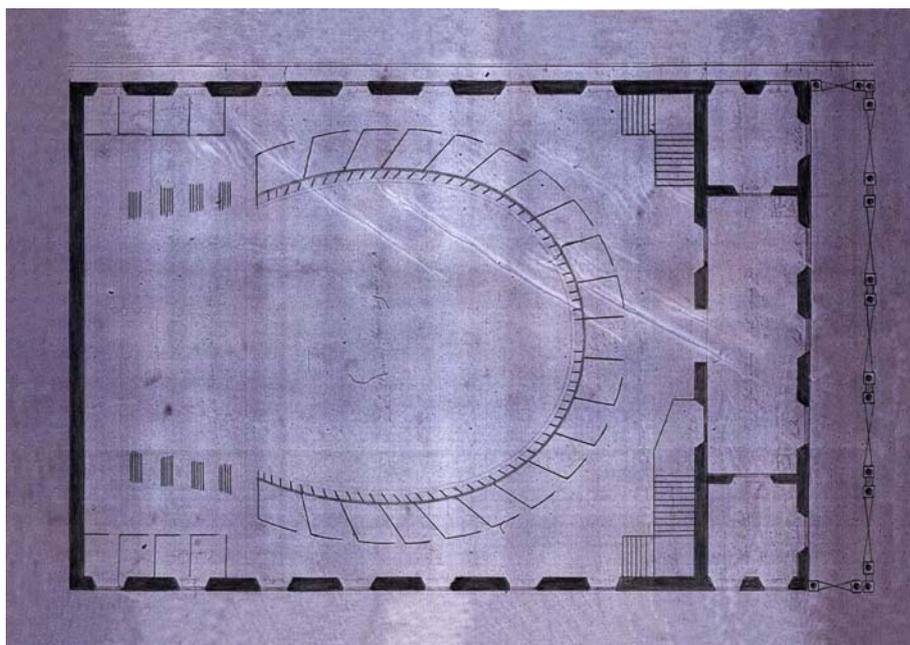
Proyecto del Teatro Reina Isabel II. Plano de planta. Projectado por Ingeniero Manuel Heredia en 1848. Fuente: Instituto de Historia y Cultura Militar de Madrid (I.H.C.M.). Cartoteca. N° plano 12.320.
